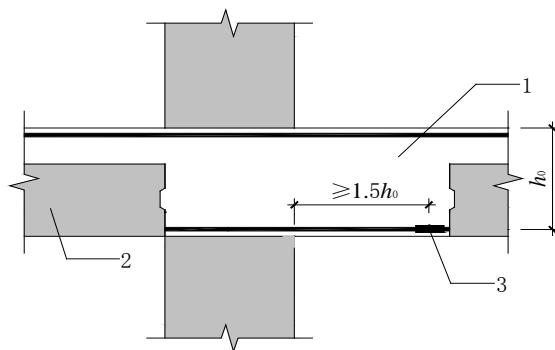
梁纵向钢筋在节点区外的后浇段内连接示意
